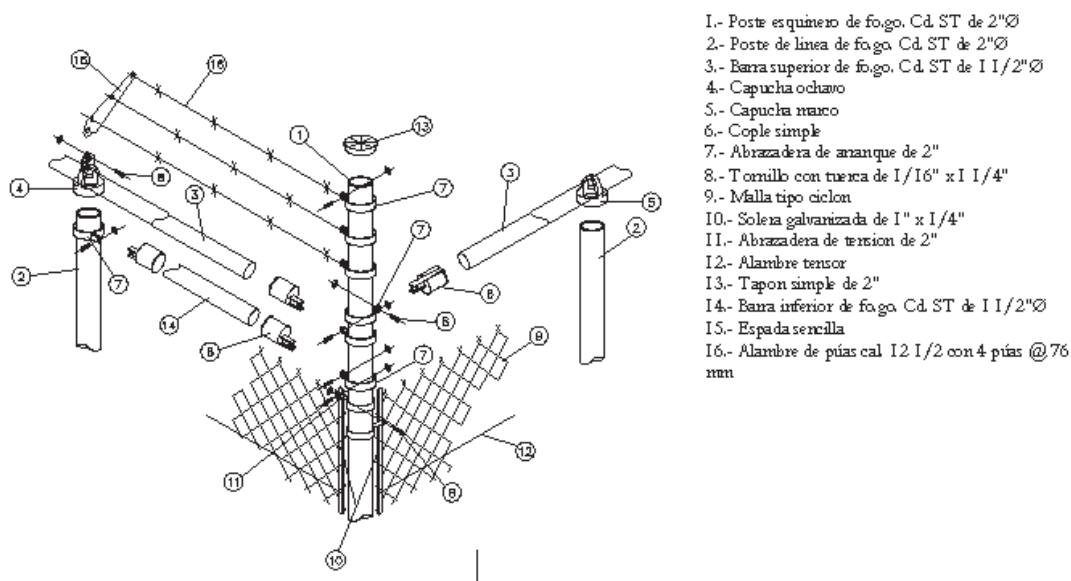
Detalle de la instalación de malla ciclónica.
